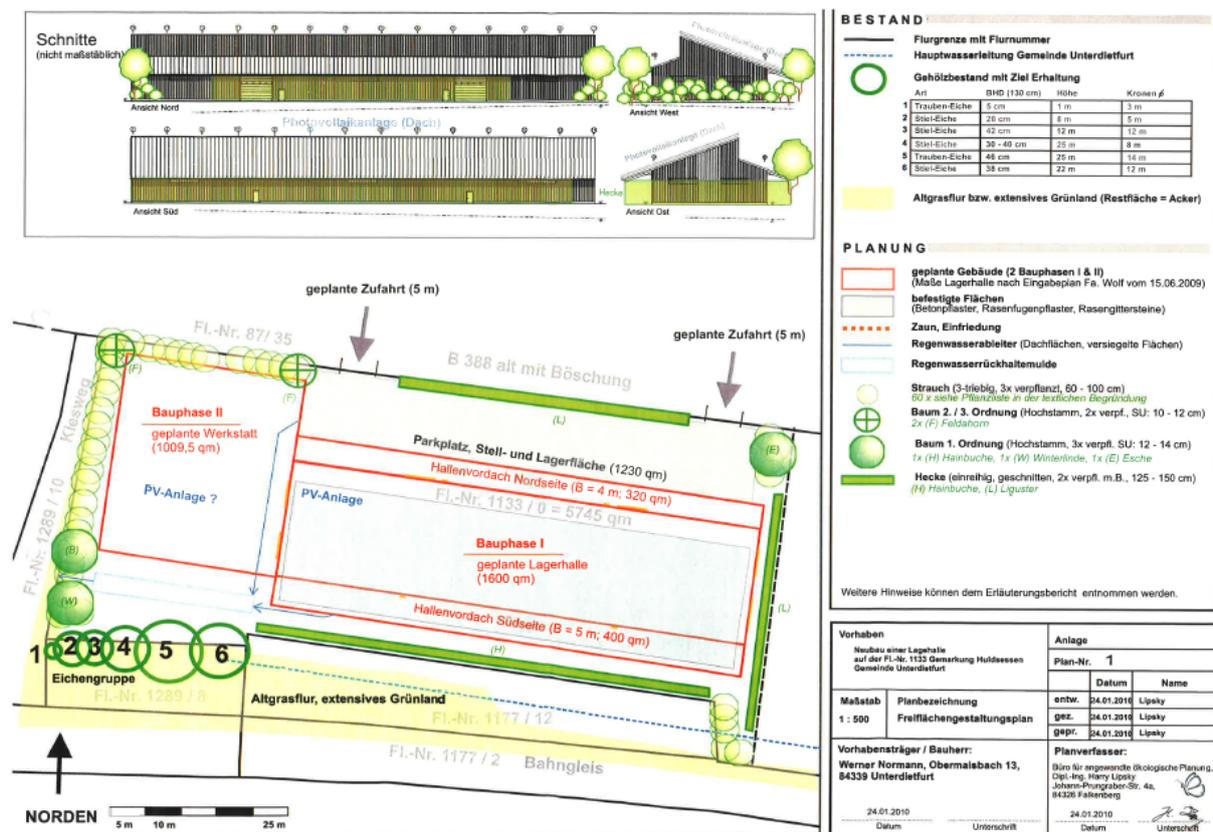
genehmigter Freiflächengestaltungsplan für Neubau einer Lagerhalle auf Flur-Nr. 1133 Gemarkung Huldressen; (Büro Lipsky, Falkenberg vom 24.01.2010), Darstellung unmaßstäblich
